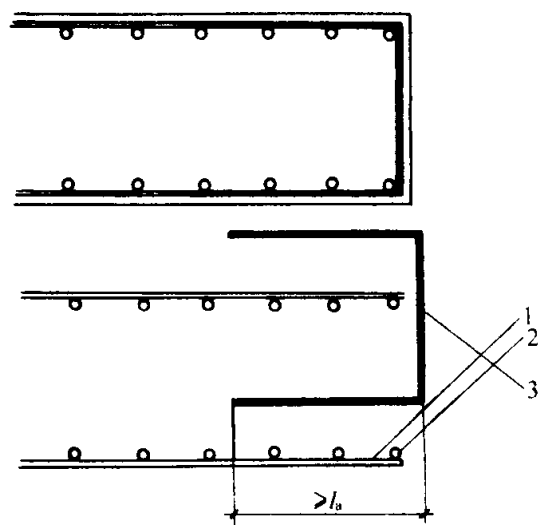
钢筋焊接网在墙体端部(无暗柱)的构造图
